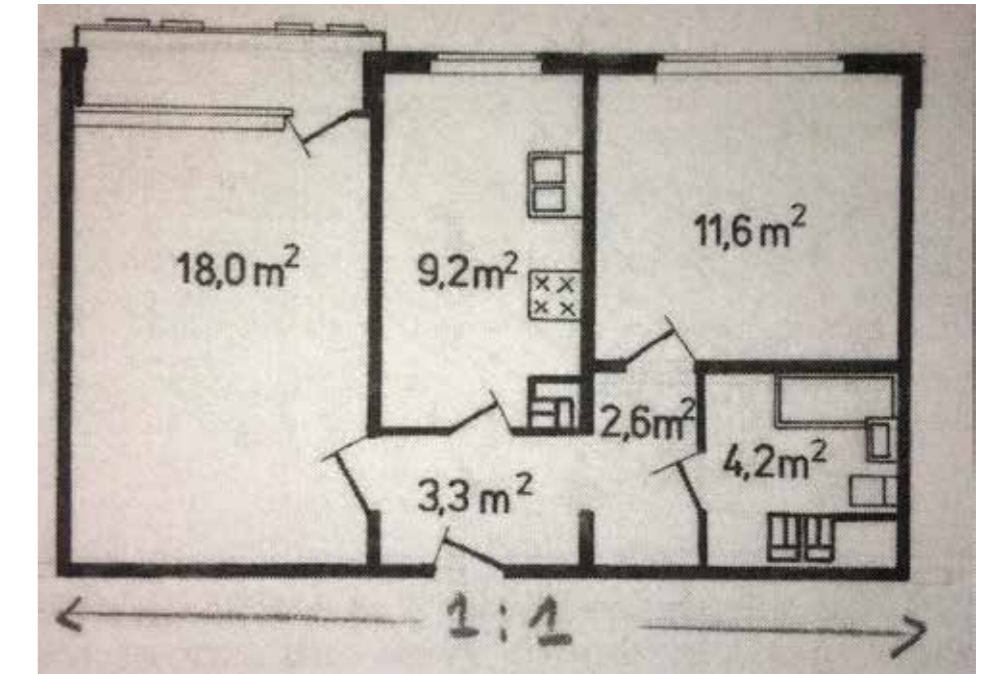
Vivienda tipo M-3 (Blokowska pg.73)
